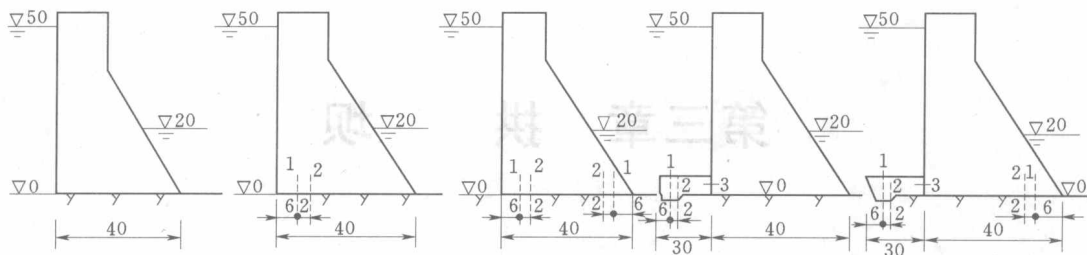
防渗帷幕、排水孔幕布置图 (单位: m)
